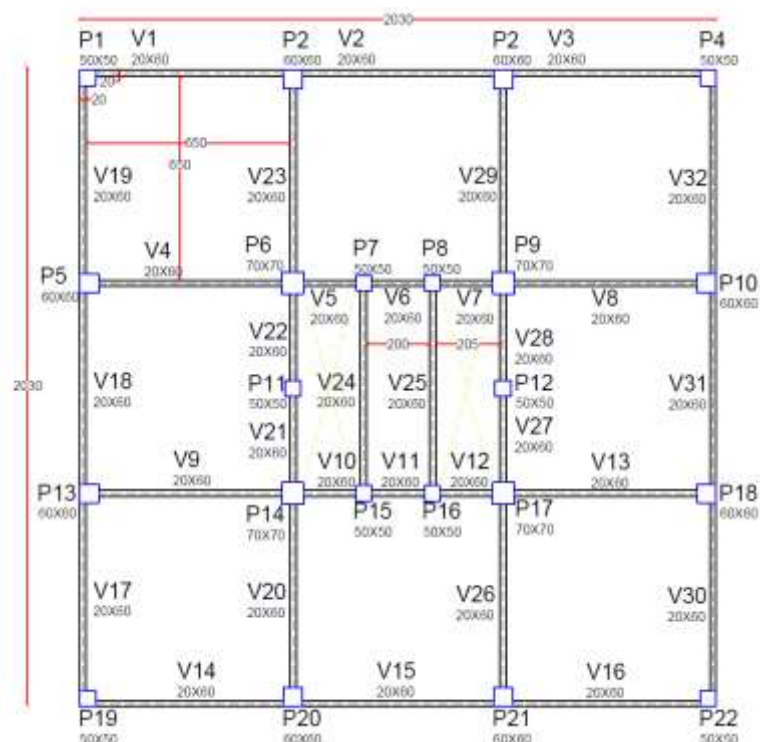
Planta de formas do pavimento tipo, estrutura aporcionada.
